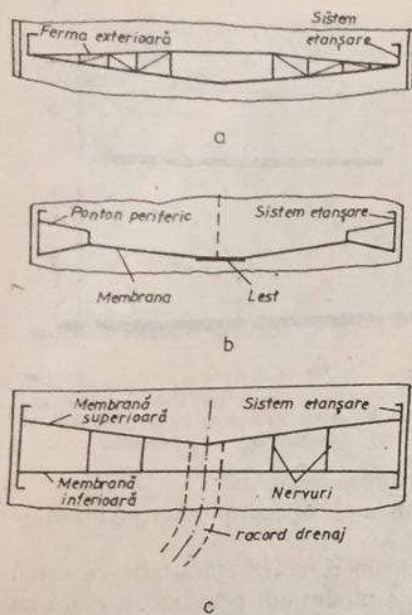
Variante constructive de capace plutitoare (scheme):
